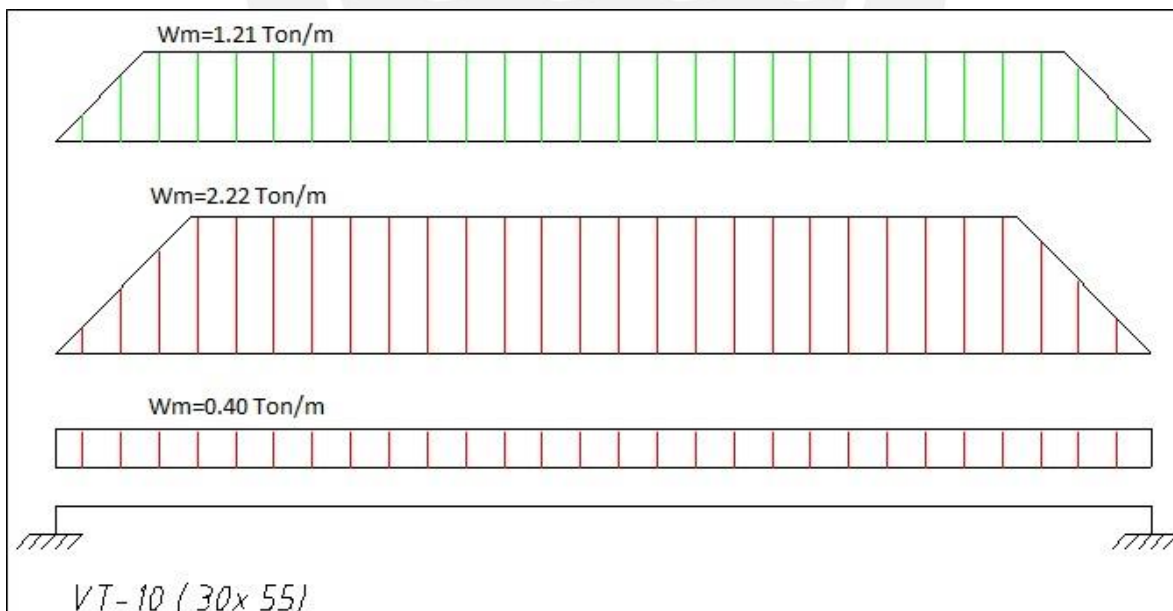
Distribución de cargas de gravedad sobre viga VT-10
